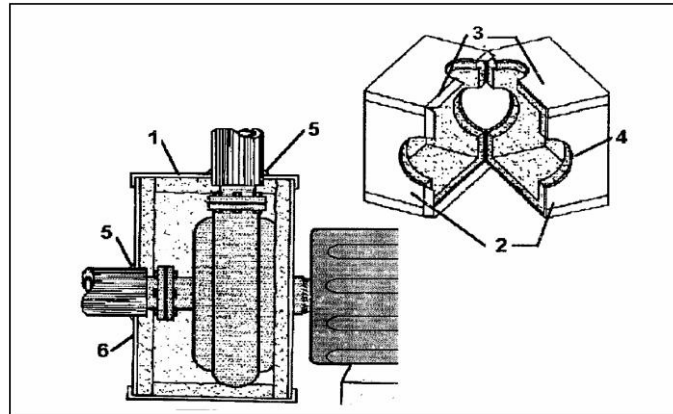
Aislamiento para cubiertas removibles de equipo metálico [4].
